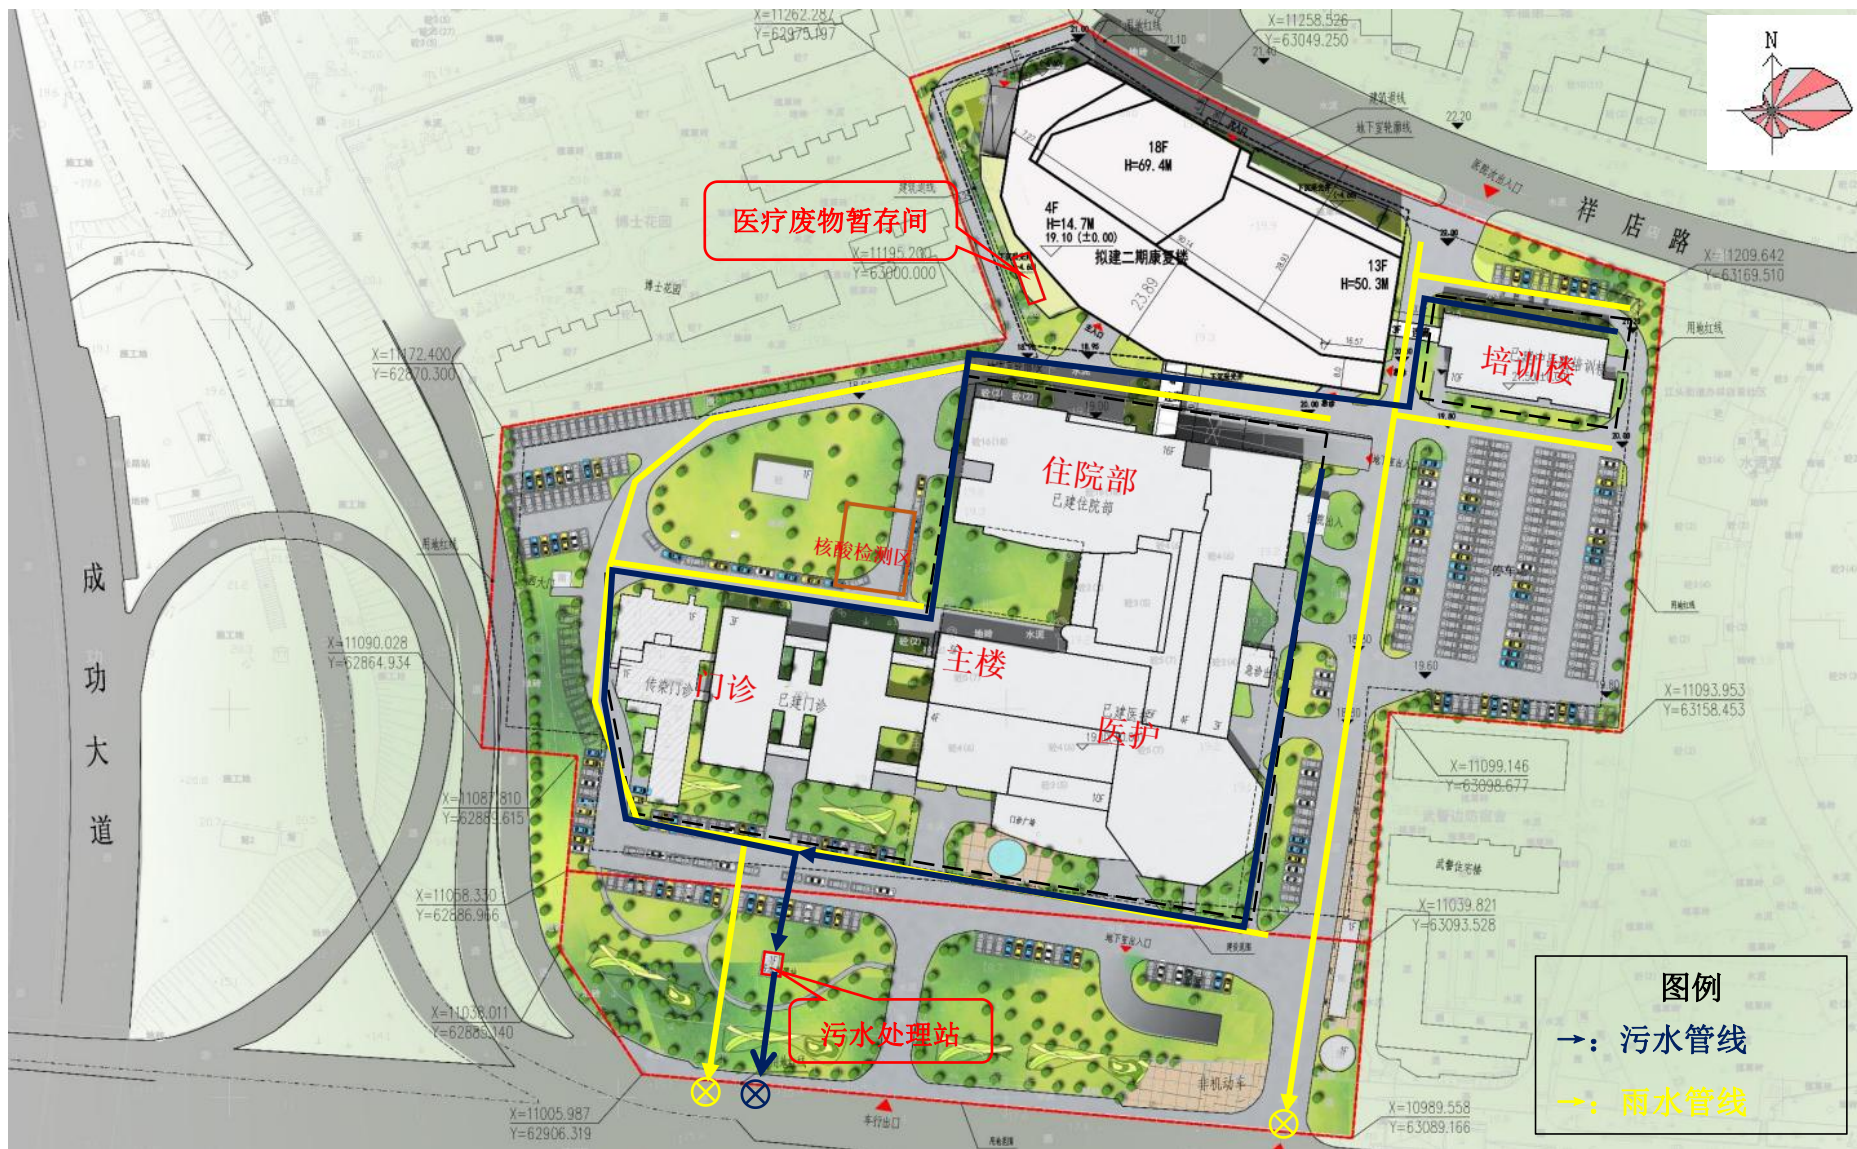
厦门市中医院现状平面示意及管网走向图
